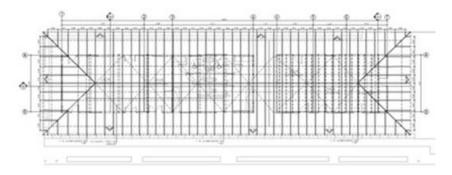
Refuerzo estructural de cubierta en madera mediante piezas de madera a nivel de cumbrera a soleras superiores para obtener resistencia ante fuerzas en sentido opuesto a los largueros de techo. (Crédito: M. B. Esquivel, 2019)
